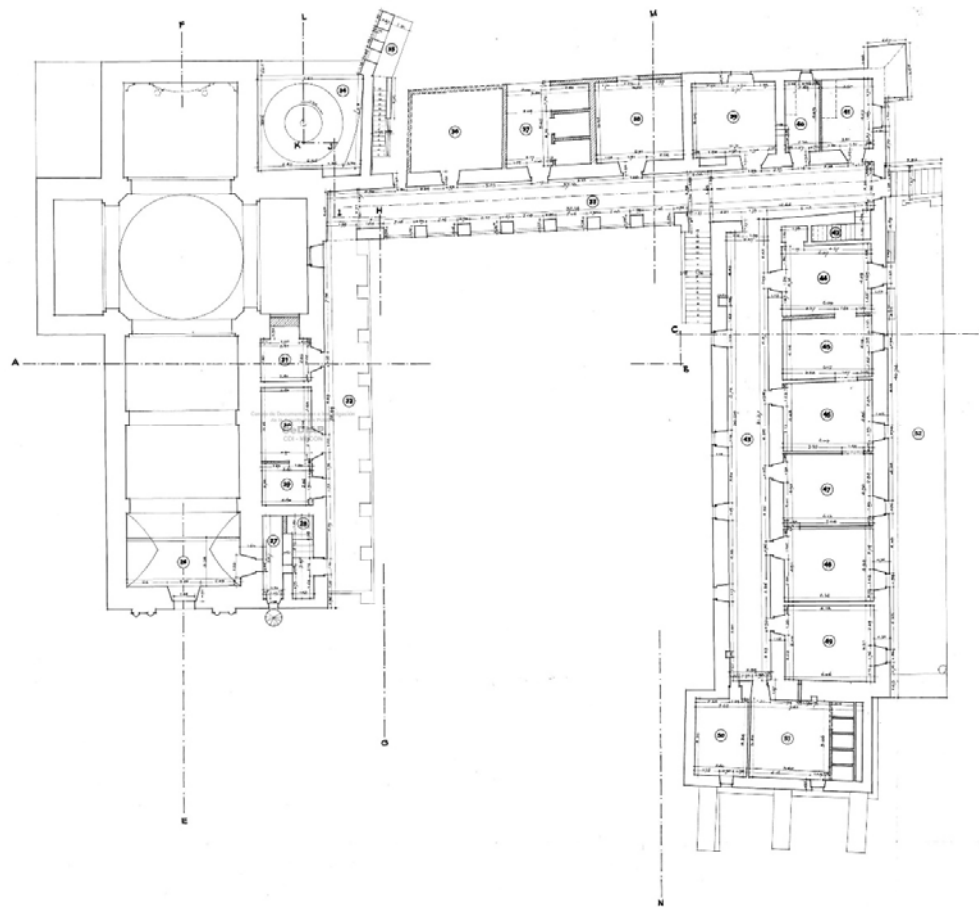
Planta Alta Estancia de Jesús María, relevamiento del Arq. Carlos Onetto. CEDIAP
